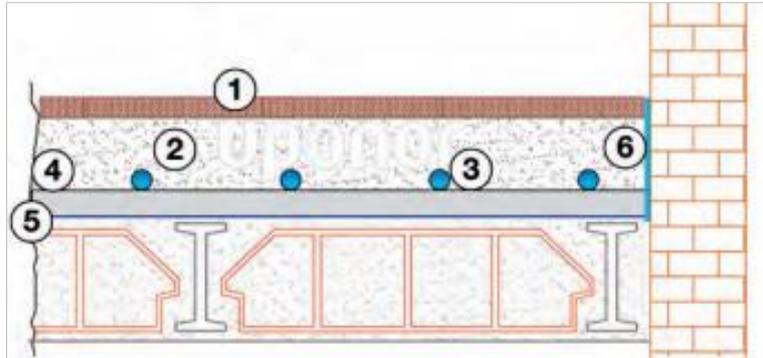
Sistema tradicional de suelo radiante. (1. Pavimento, 2. Capa de mortero, 3. Tuberías, 4. Panel aislante, 5. Barrera antihumedad, 6. Banda perimetral)
